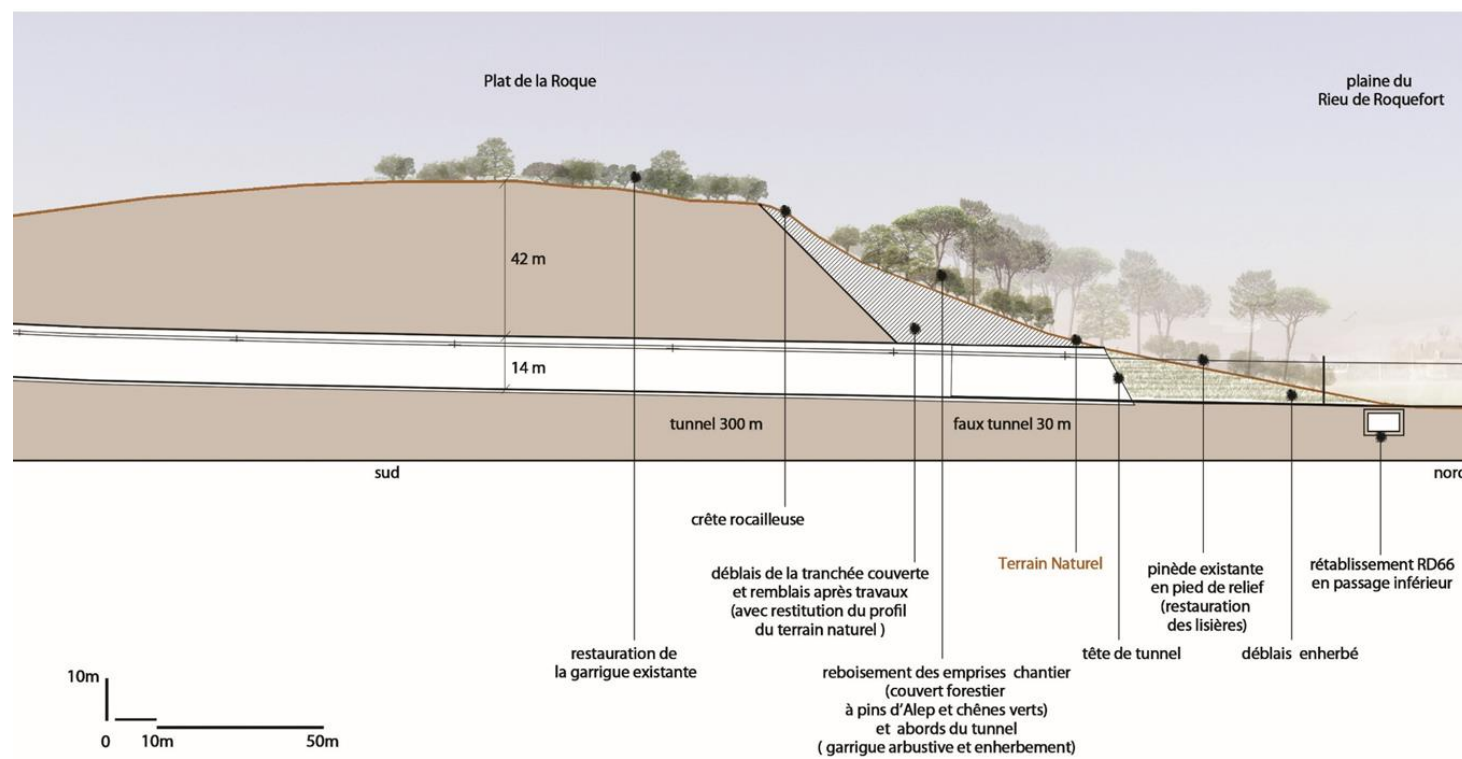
profil en long du tunnel de Roquefort-des-Corbières (source : Traverses)
